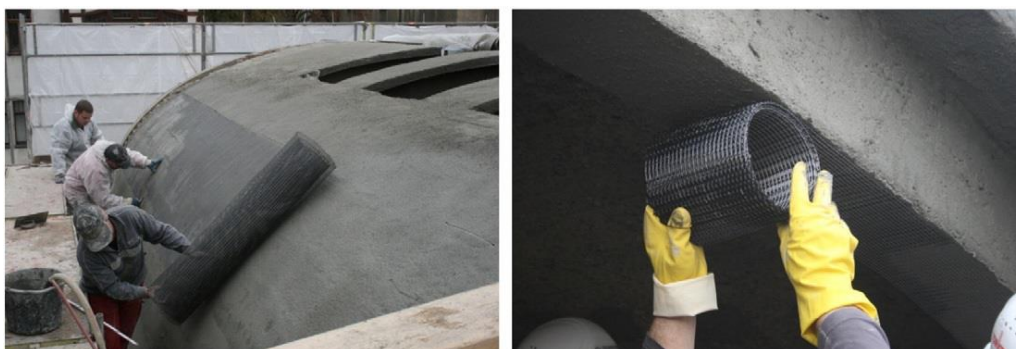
Souvrství TRC-pórobeton-TRC [14]
